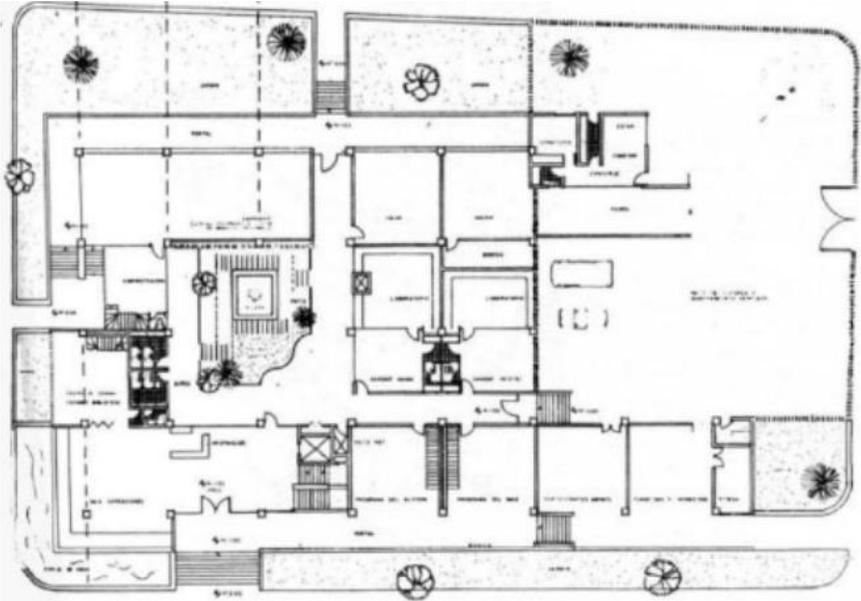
| Planta baja. Fuente: Libro BAQ, 1980.
